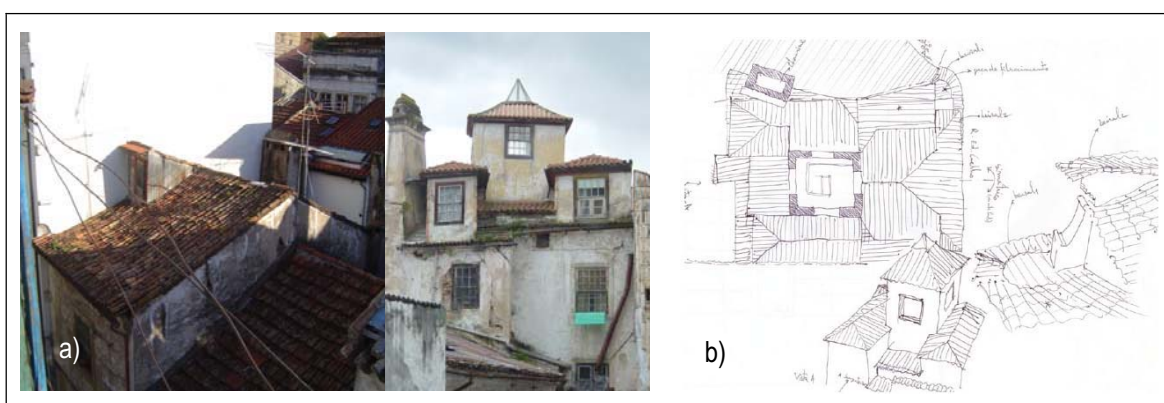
Coberturas: a) Mau estado de conservação; b) Pormenor do levantamento das coberturas
